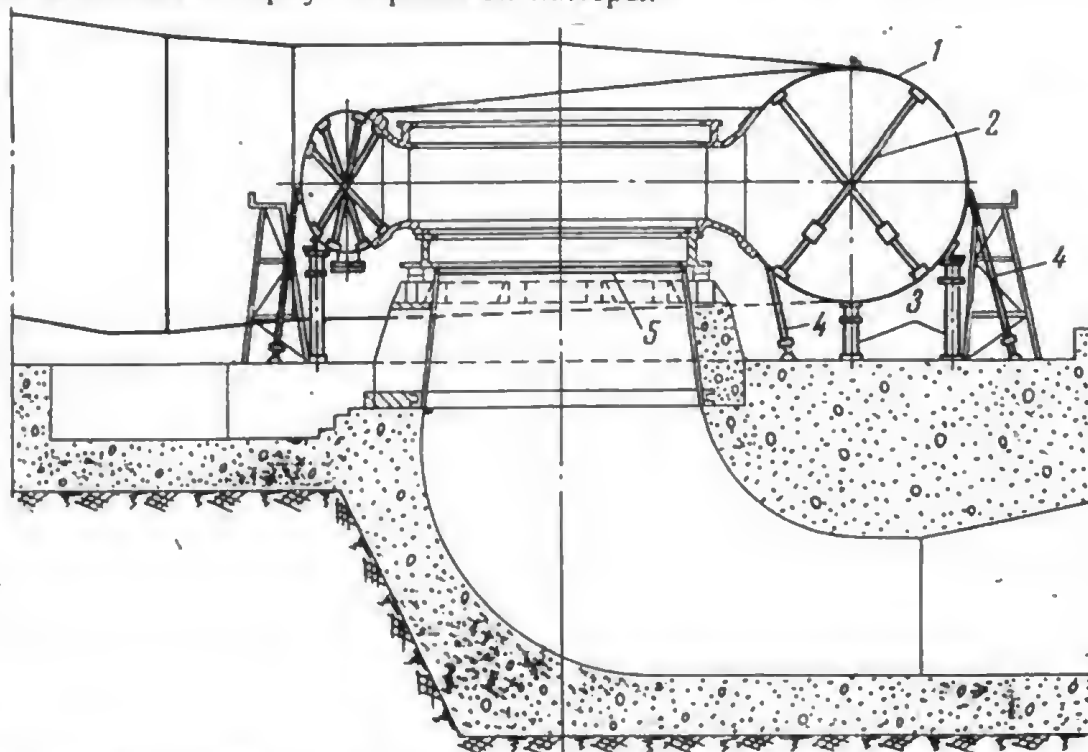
Установочная схема сварной спиральной камеры.
